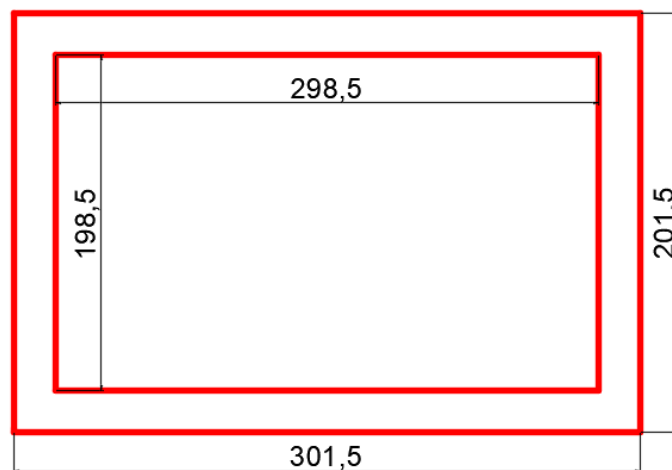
Vista en planta laguna de maduración de 1,00 m de profundidad.
